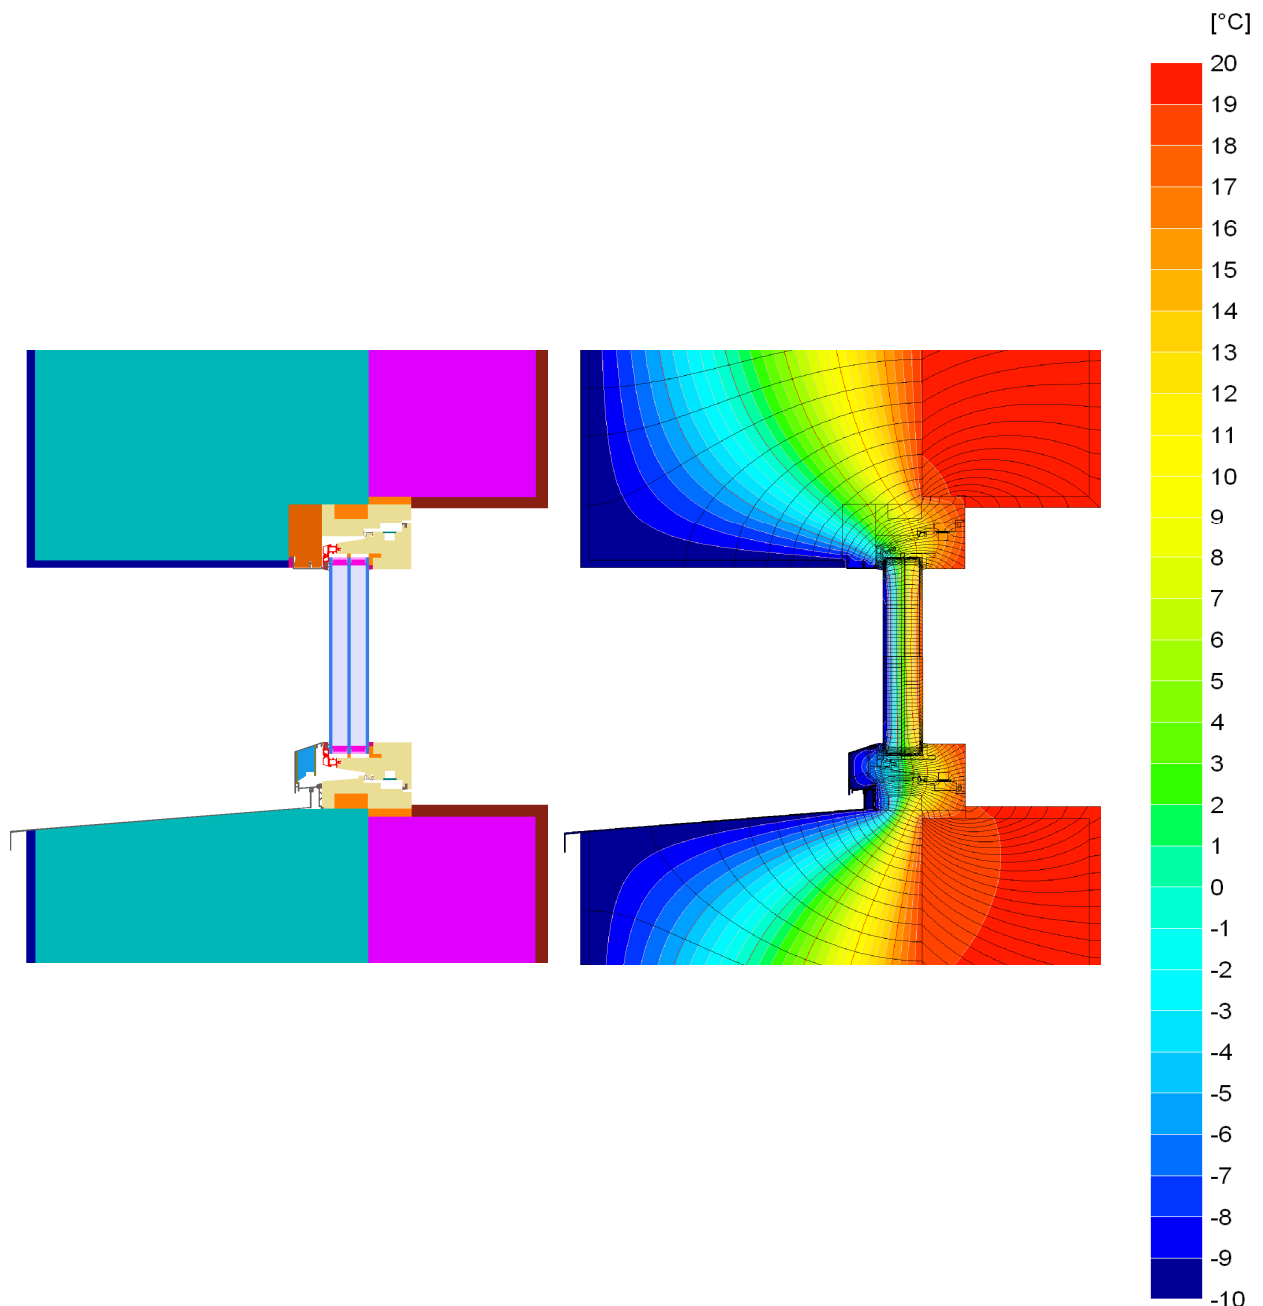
Einbausituation 'unten' und 'seitlich/oben' für eine Mauerwerkswand mit Wärmedämmverbundsystem mit zugehörigen Isothermenbildern
